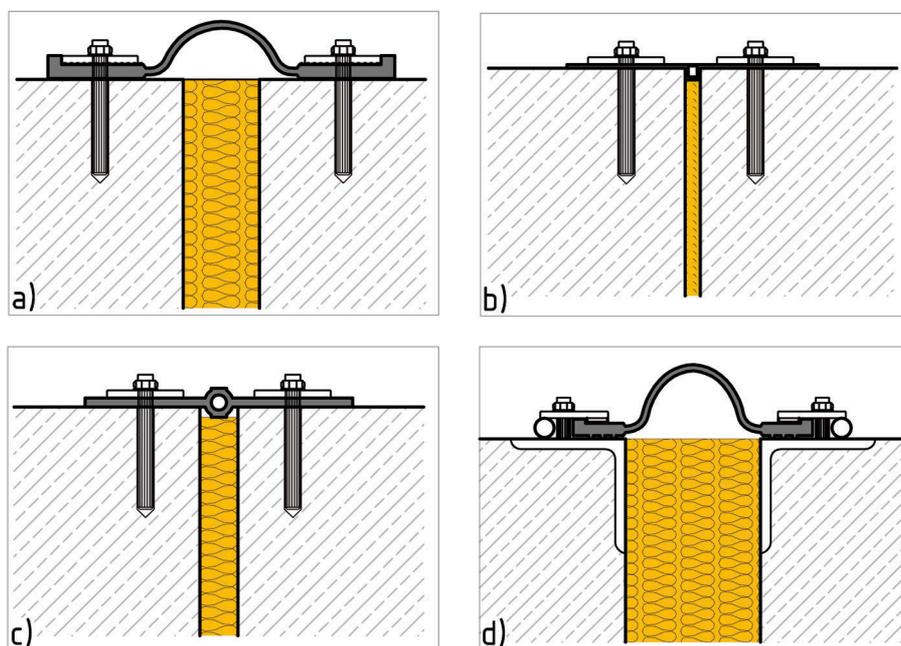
Klemmfugenbänder mit beidseitiger Klemmung – Klemmflansch aus nichtrostendem Stahl z. B. feuerverzinkt oder Edelstahl: a) Omegaprofil mit Flachklemmflansch, b) Fugenbandklemmkonstruktion aus Nitriflex nach DIN 18541, z. B. D320, c) Fugenbandklemmkonstruktion aus Elastomer nach DIN 7865, z. B. FM 350, d) Omegaprofil mit Drehkipplansch Los-Fest-Flanschkonstruktion, z. B. OKB 35
